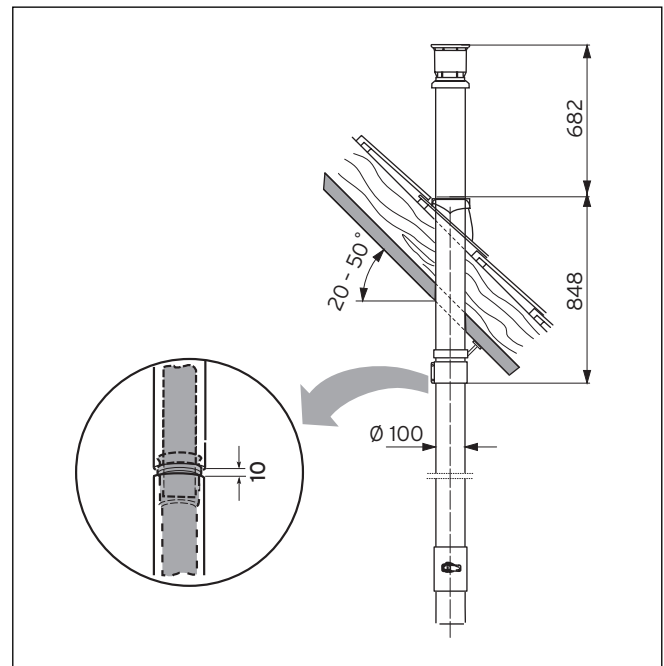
Montagebeispiel: Senkrechte Dachdurchführung
